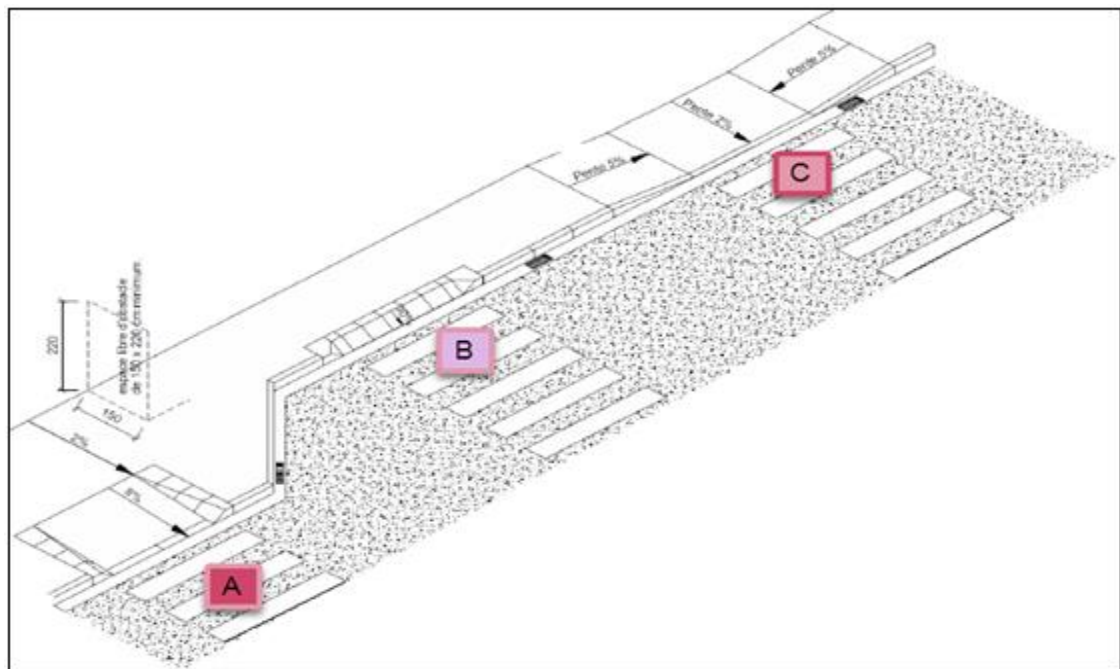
Les inflexions de trottoir au droit des traversées piétonnes.
